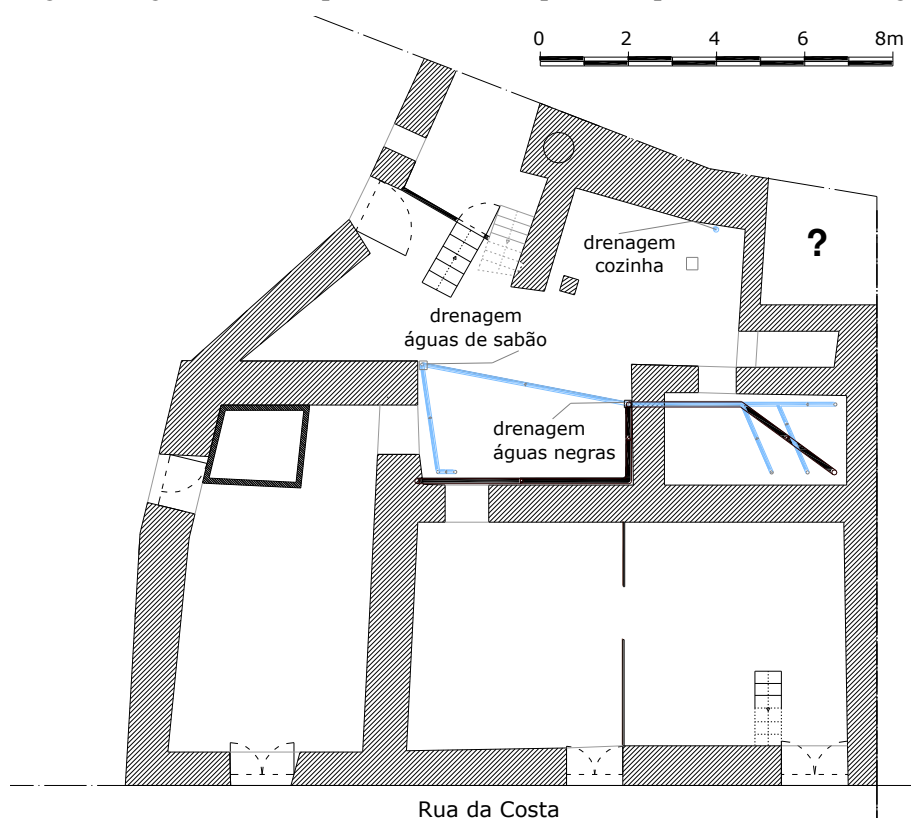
27 – Planta esquemática da rede de drenagem de águas residuais domésticas.
